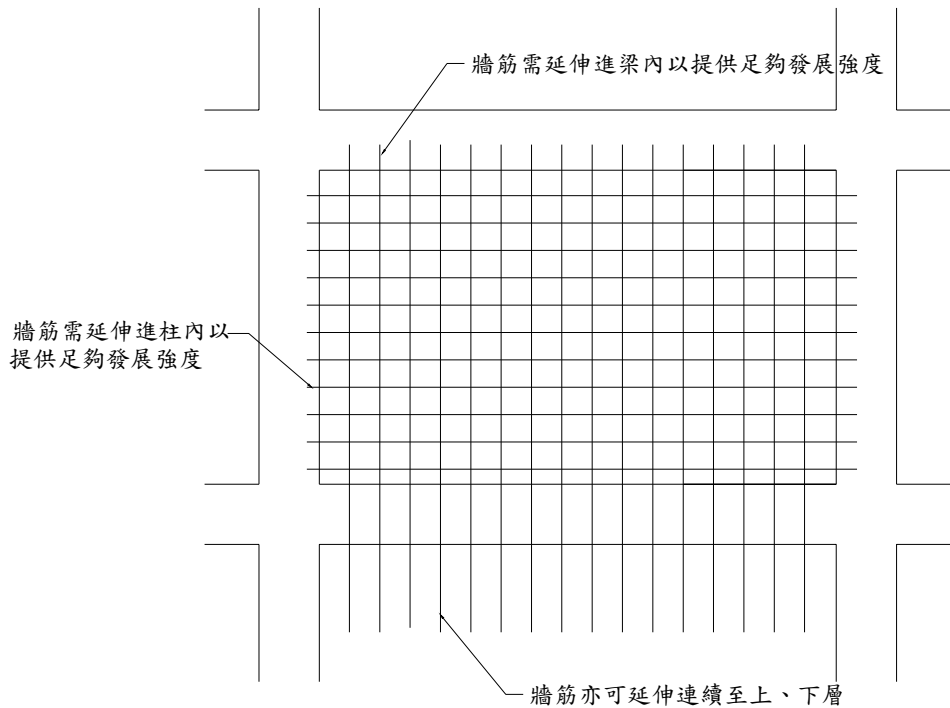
鋼筋混凝土牆鋼筋配置細節需求
